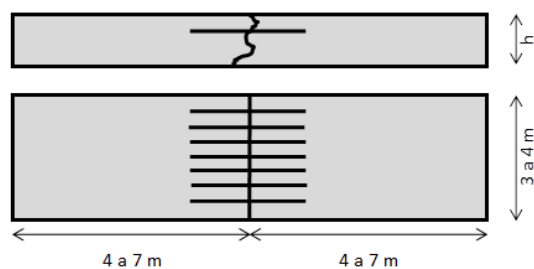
Pavimento de concreto com armadura descontínua sem função estrutural
